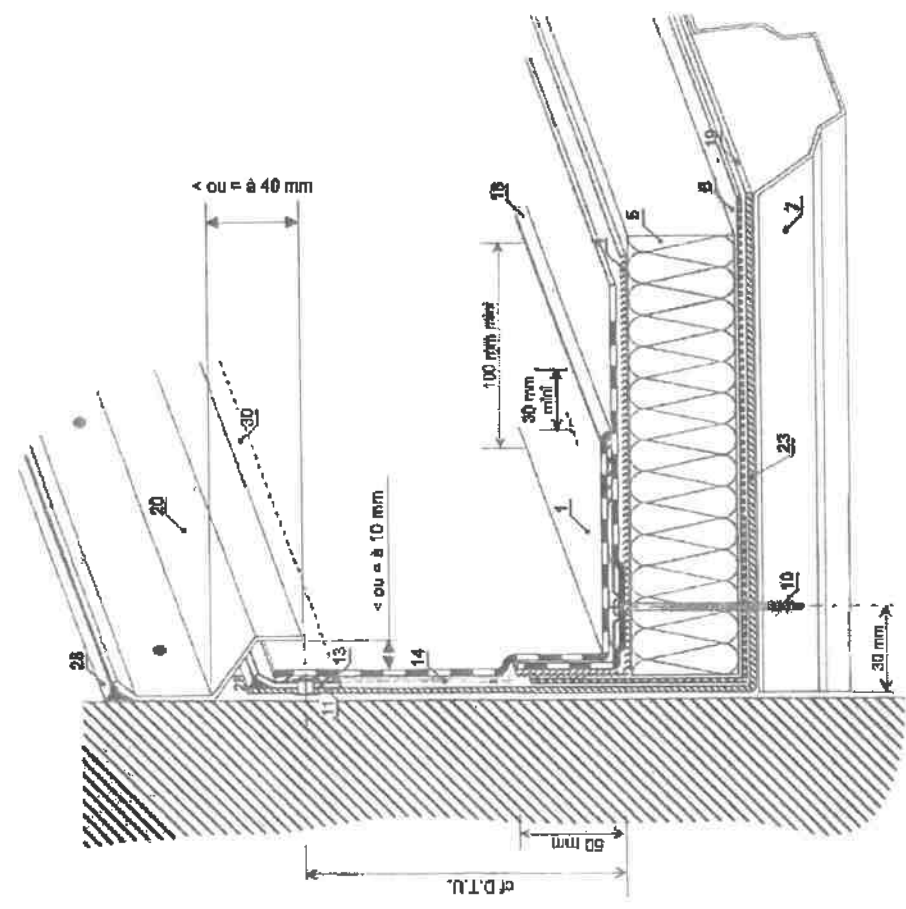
Relevé d'étanchéité - coupe sur bac acier travaux neufs
